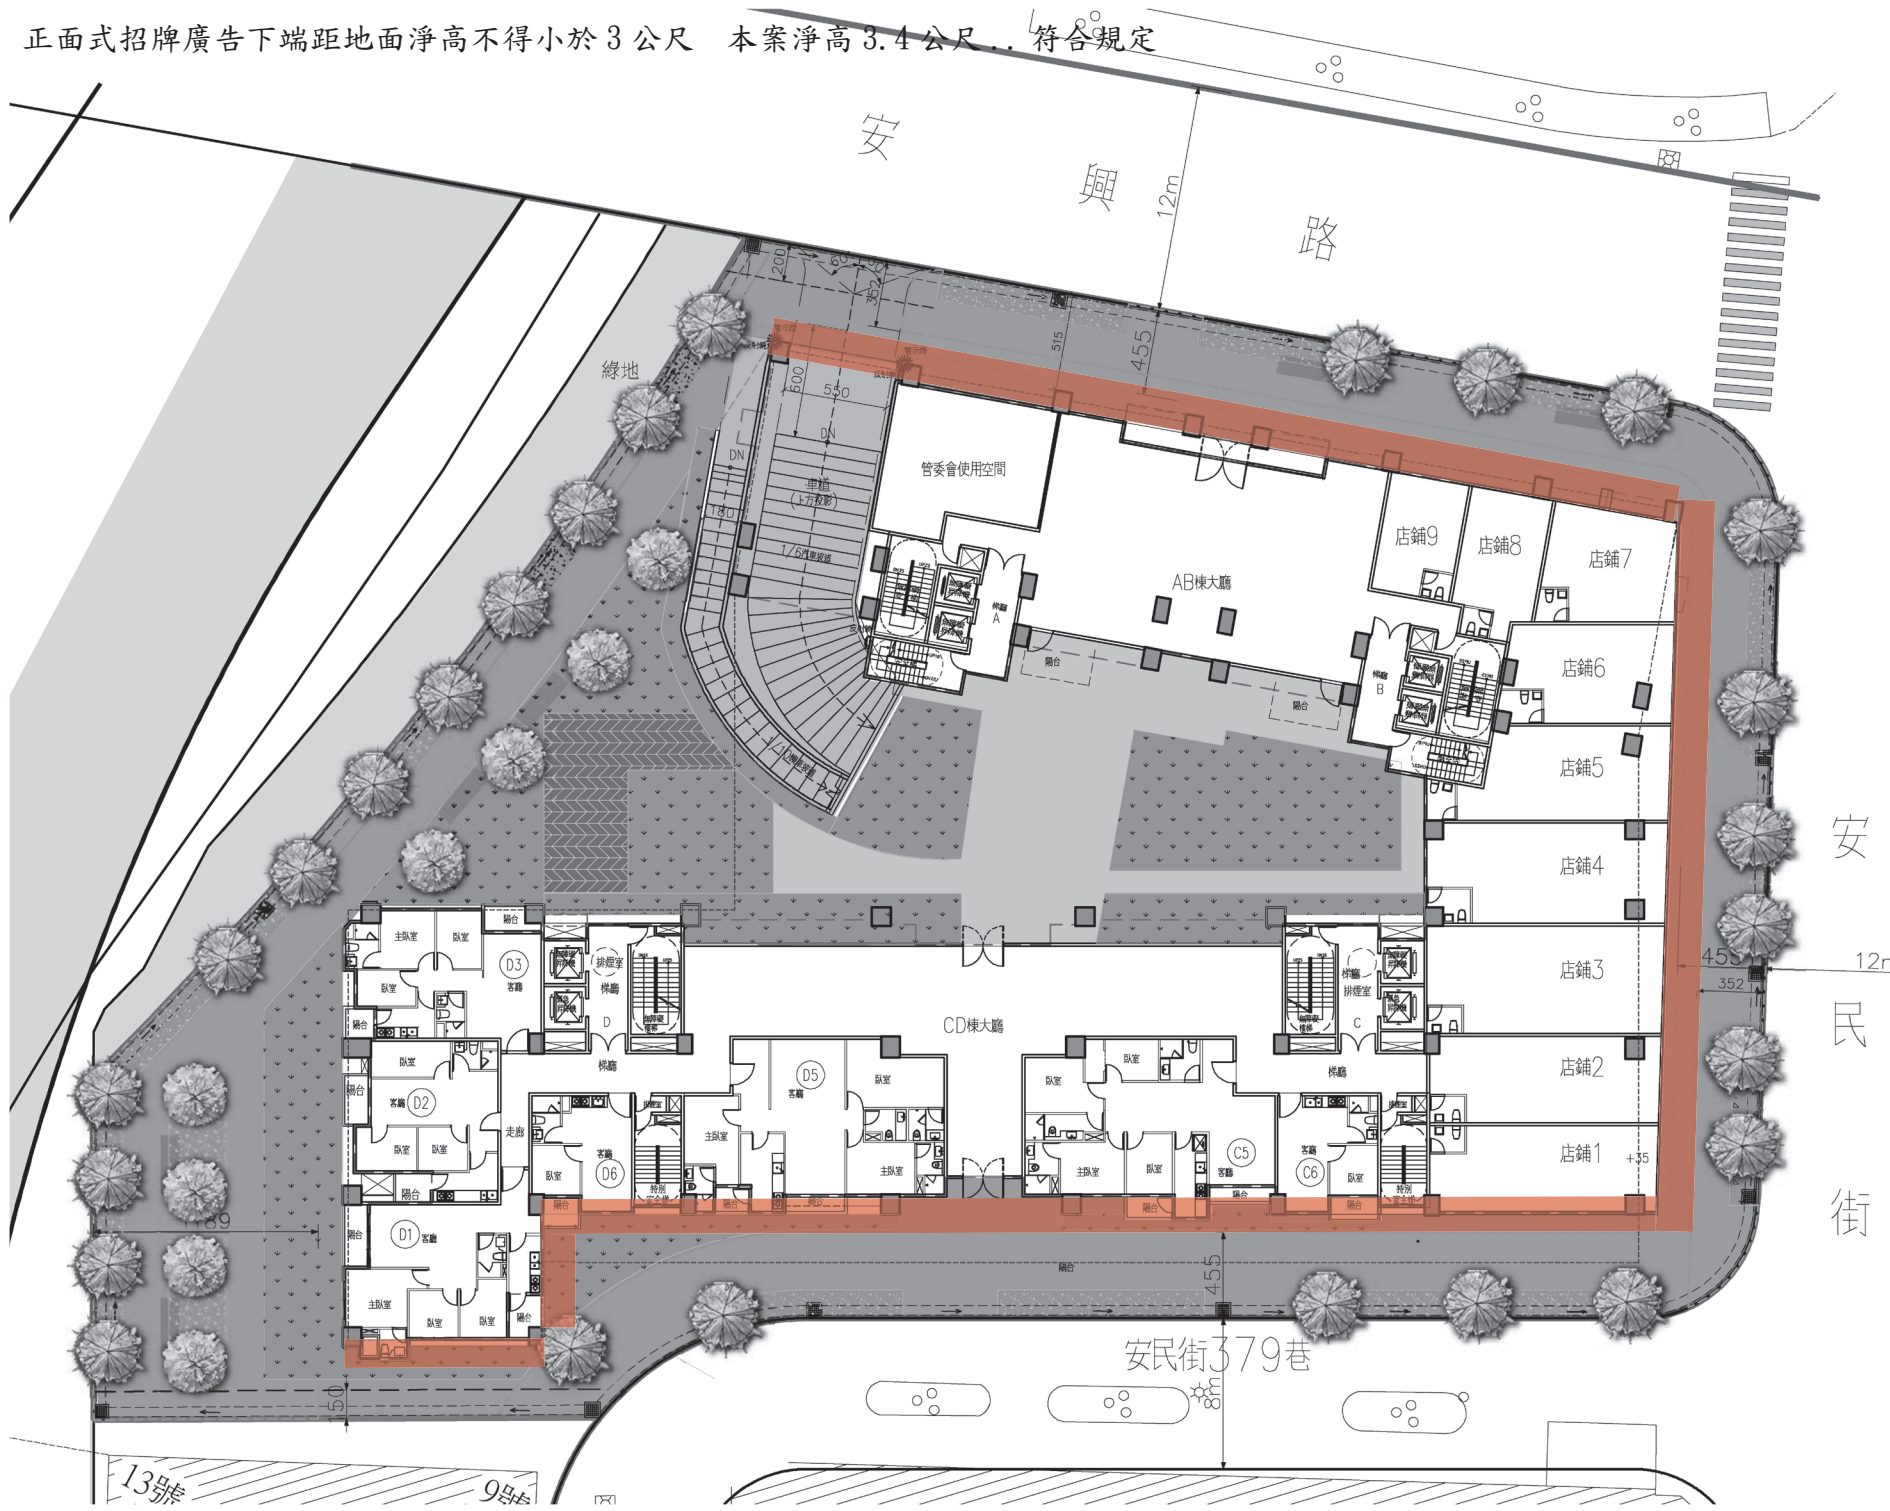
店招位置平面圖 SCALE: A3:1/400
